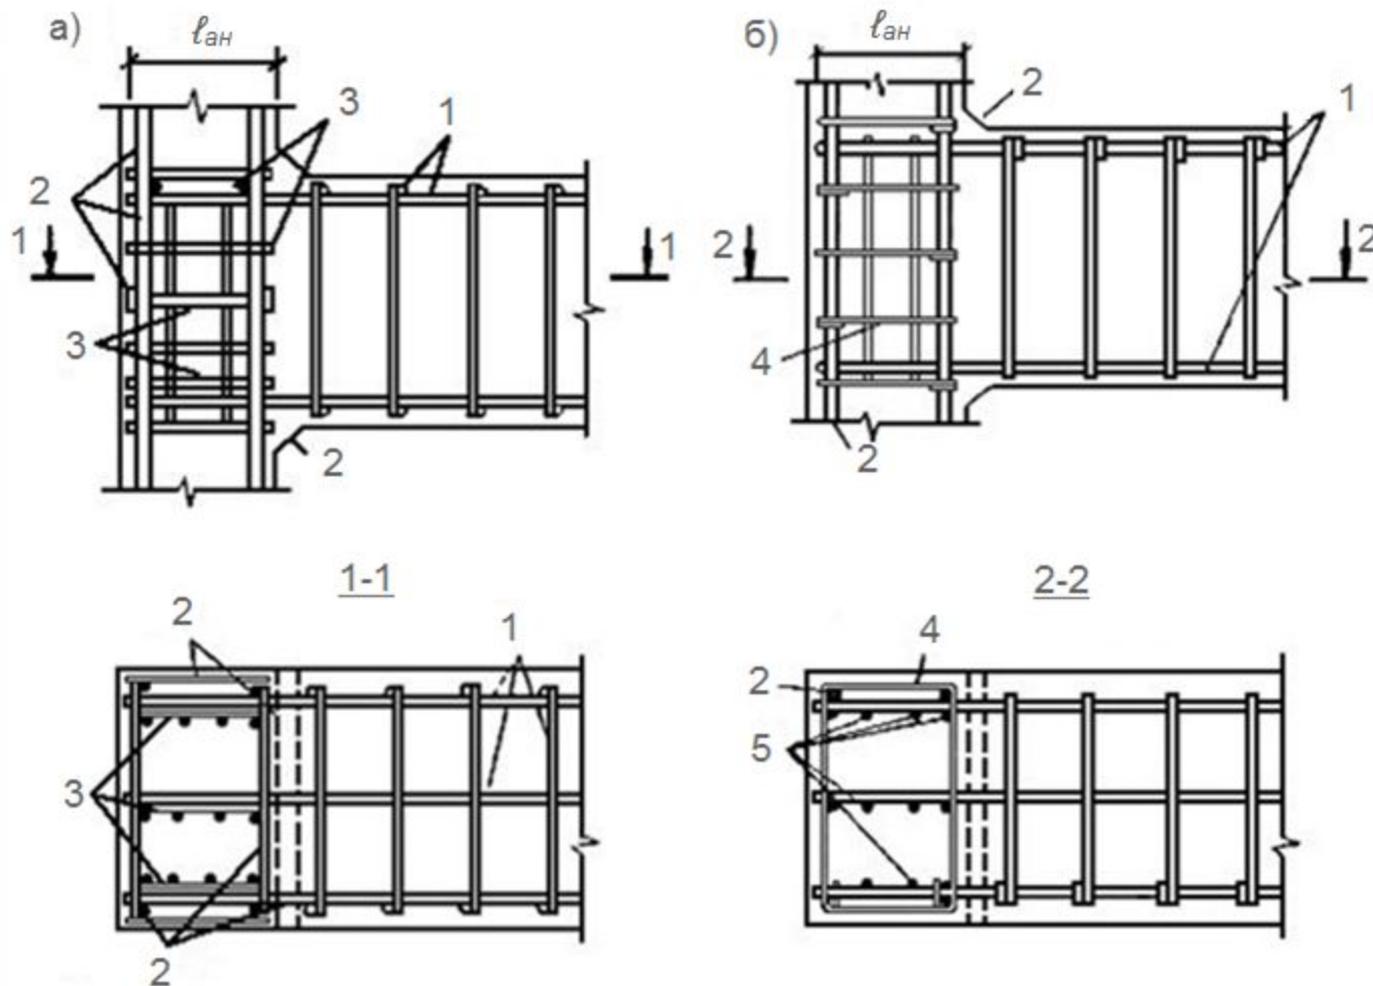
Конструирование сопряжения промежуточной распорки с ветвью двухветвевой колонны :
